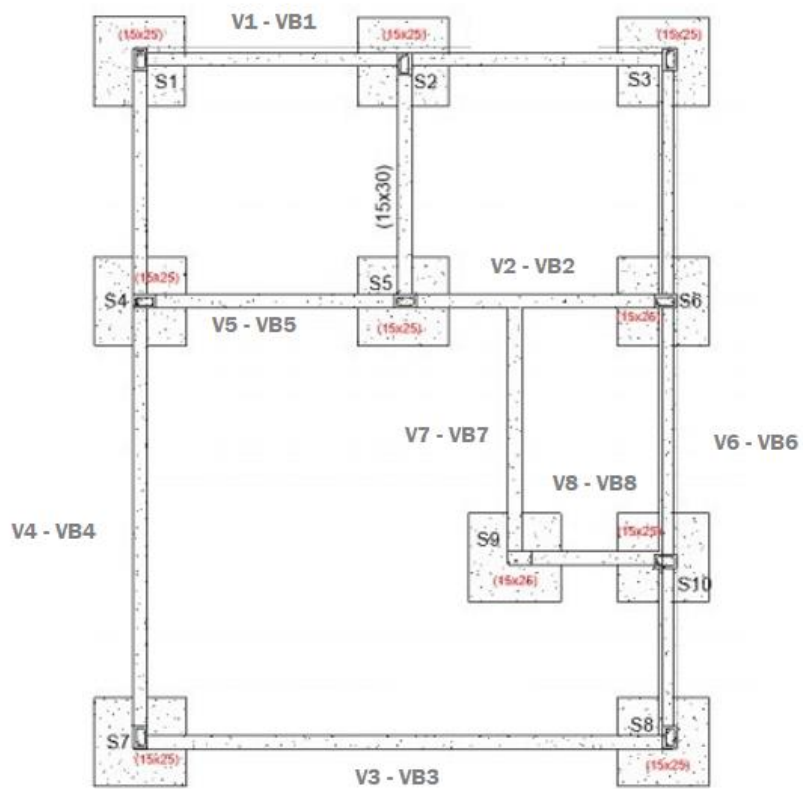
Croqui das vigas, vigas baldrame, pilares e sapatas
